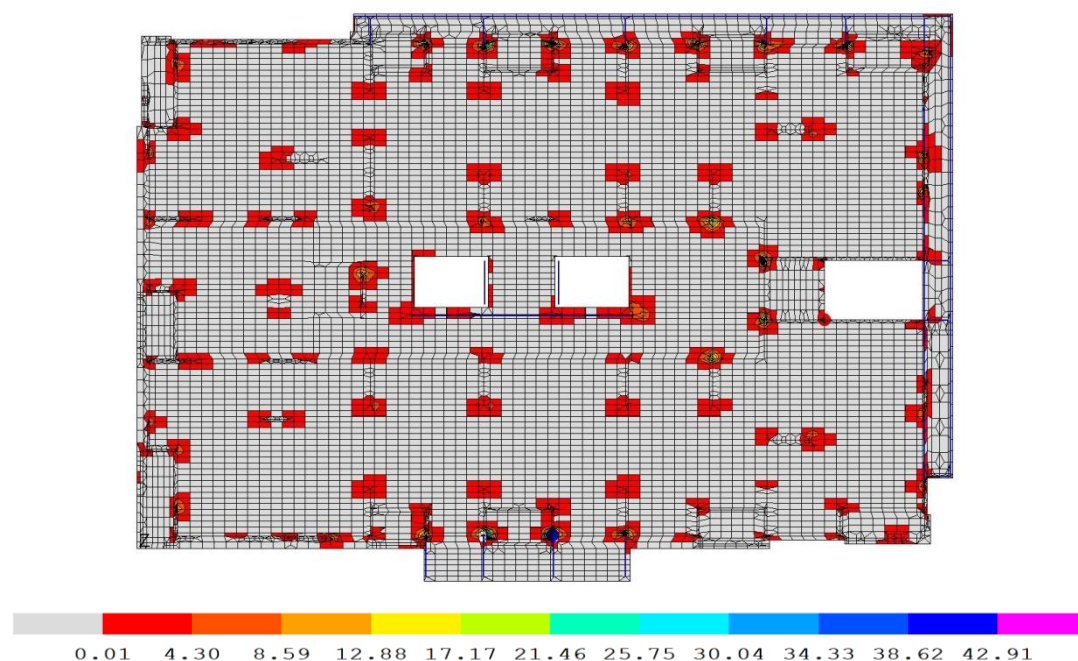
СтаДиКон. Поперечное армирование A_{sw}
